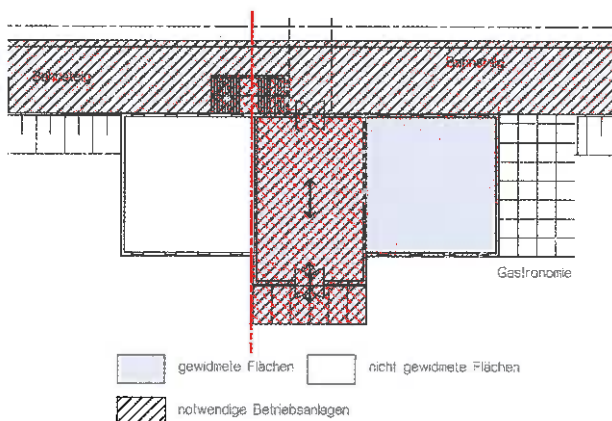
Notwendiger Zugang durch Gebäude mit Gebäudetrennung
